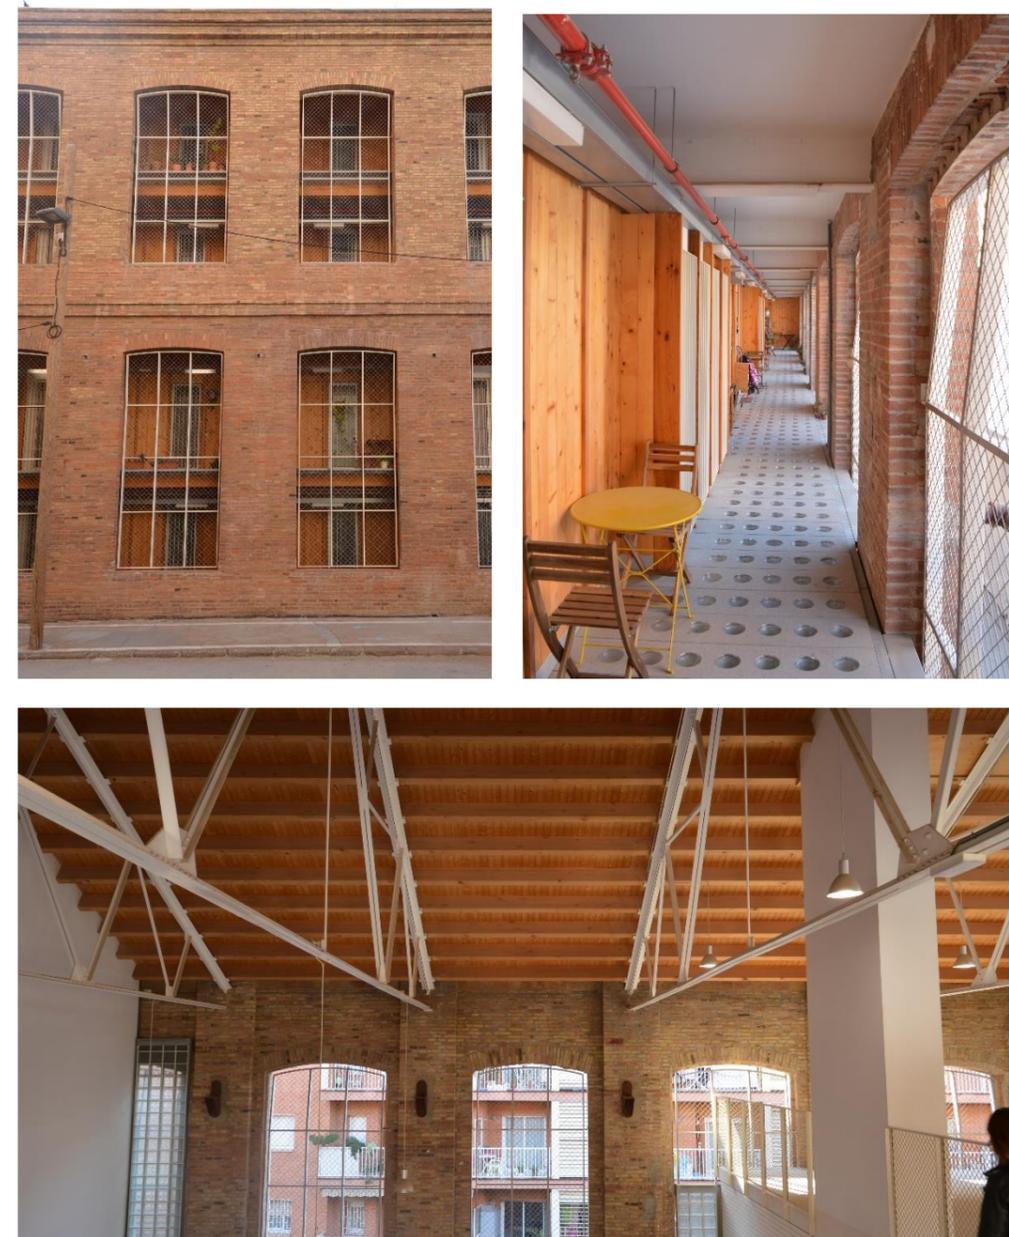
IMAGENES. Fachada, corredor de acceso a las viviendas y cerchas metálicas de la intervención en la nave G de Fabra i Coats. Fuente: Elaboración propia.
